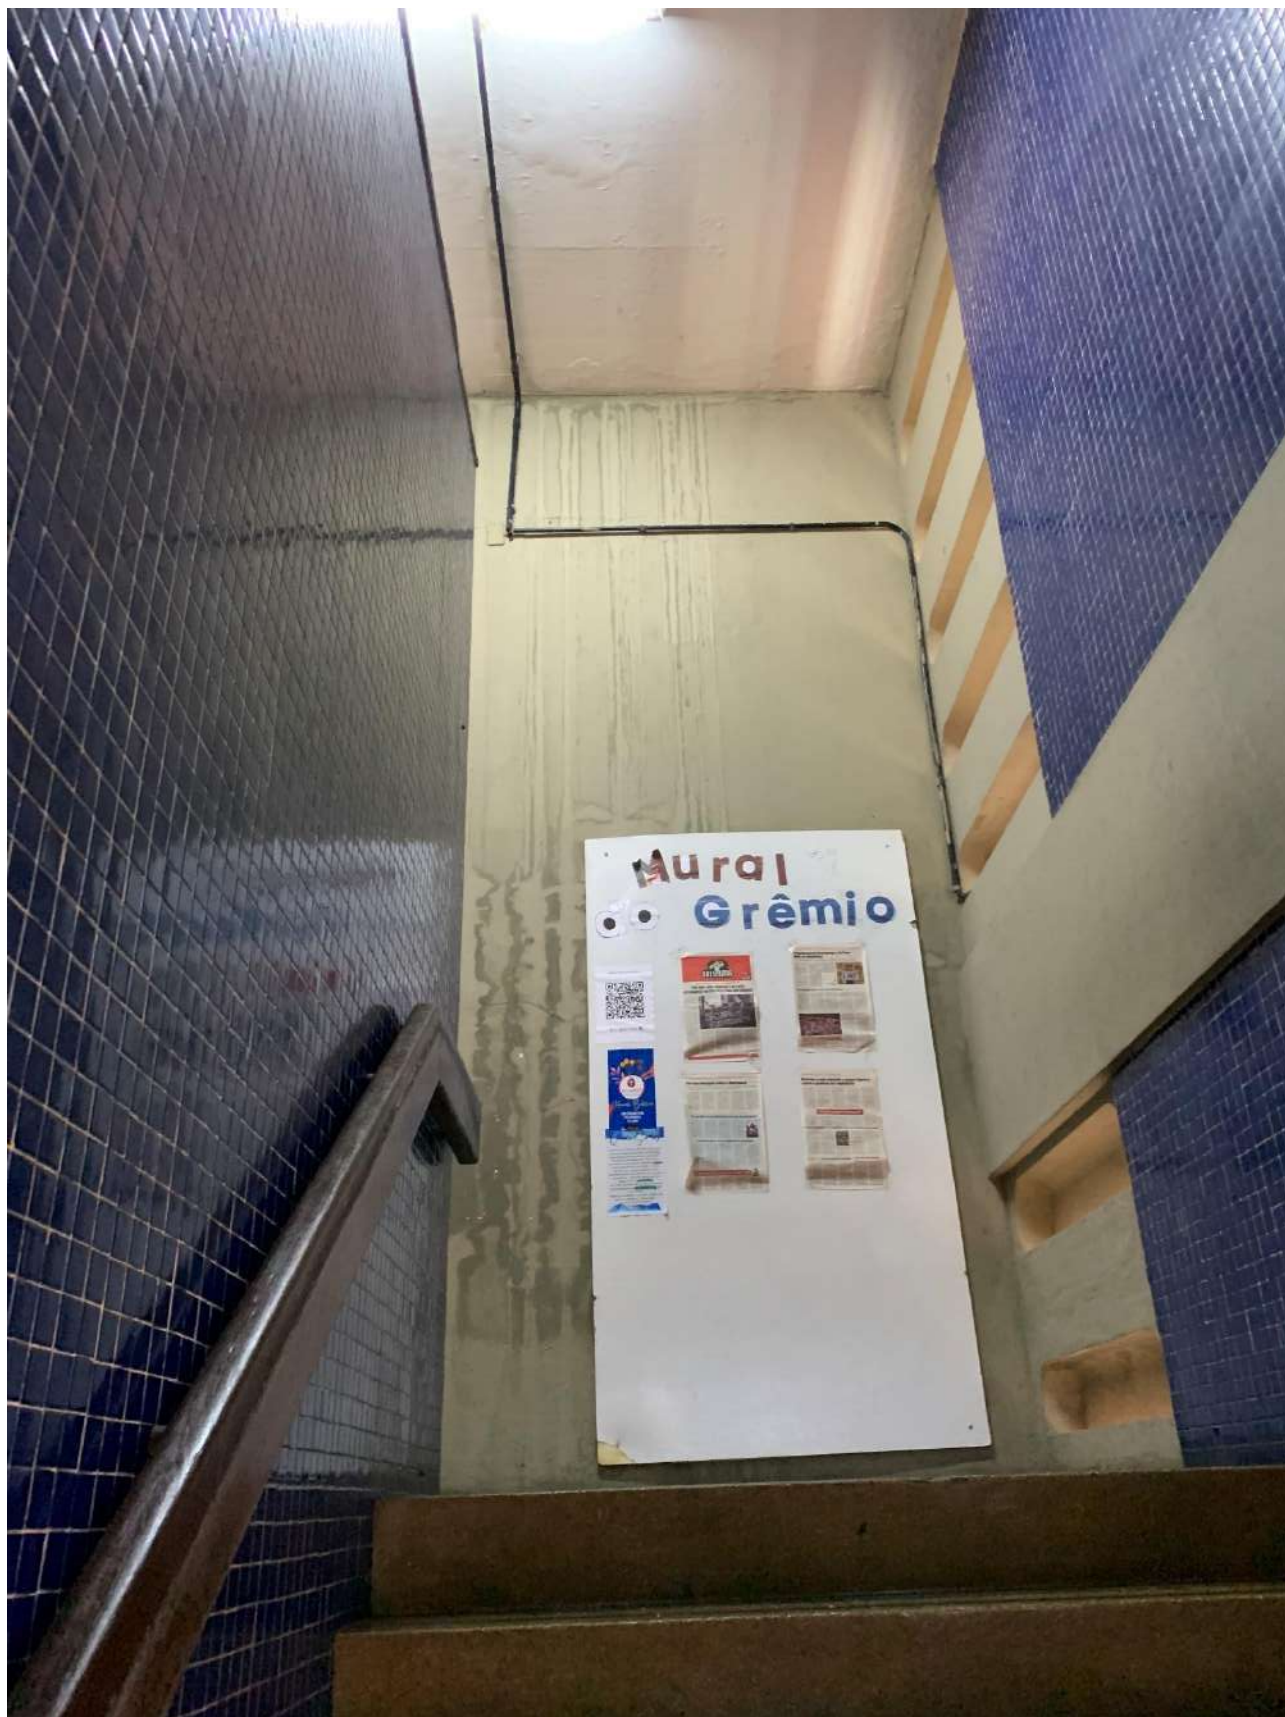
Escadaria molhada pela infiltração 1º pavimento CAP
